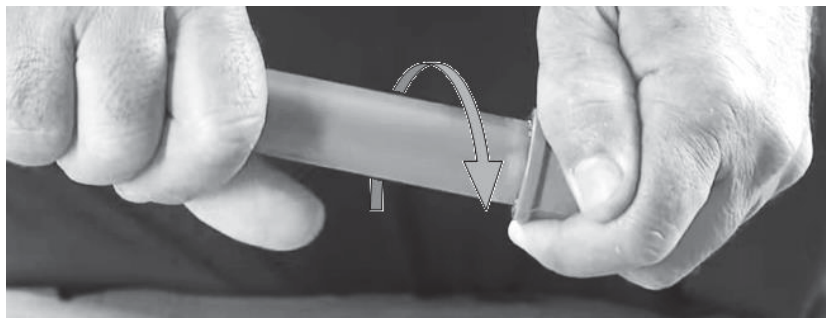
Adesivo sendo aplicado na superfície a ser soldada
